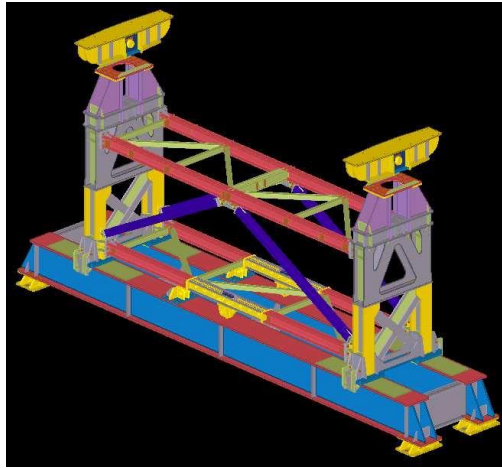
Modelo 3D do pórtico de lançamento
